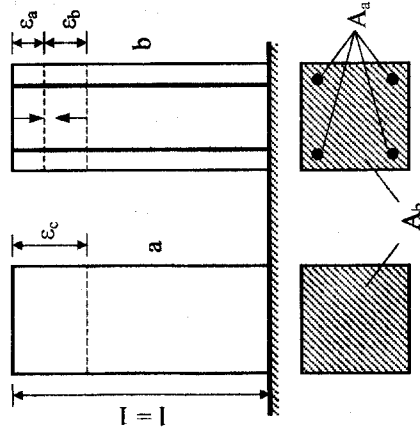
Con tracția betonului simplu (a) și a betonului armat (b)
